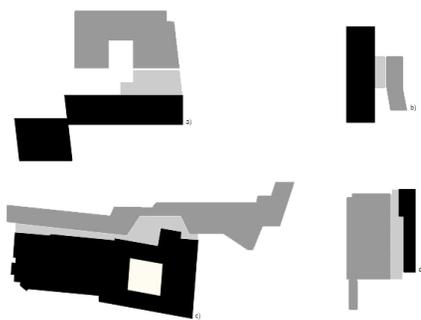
Esquemas en planta a) Hotel 'Old Mill Belgrade' (Graft Architects); b) Centro Cívico de Ferreries (Camps y Felip); c) Museo de San Telmo (Nieto Sobejano); d) Museo de Bellas Artes de A Coruña (Gallego Jorreto). Yuxtaposición: negro, elemento preexistente; gris claro, intersticio; gris oscuro, elemento contemporáneo
